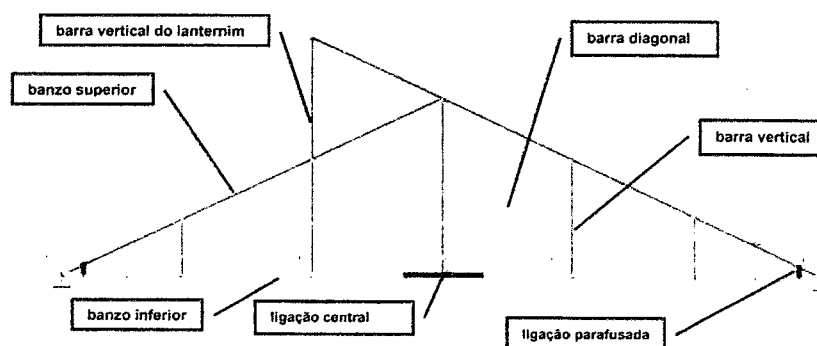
Esquema de treliça Tipo 2 com nome dado às peças estruturais.
